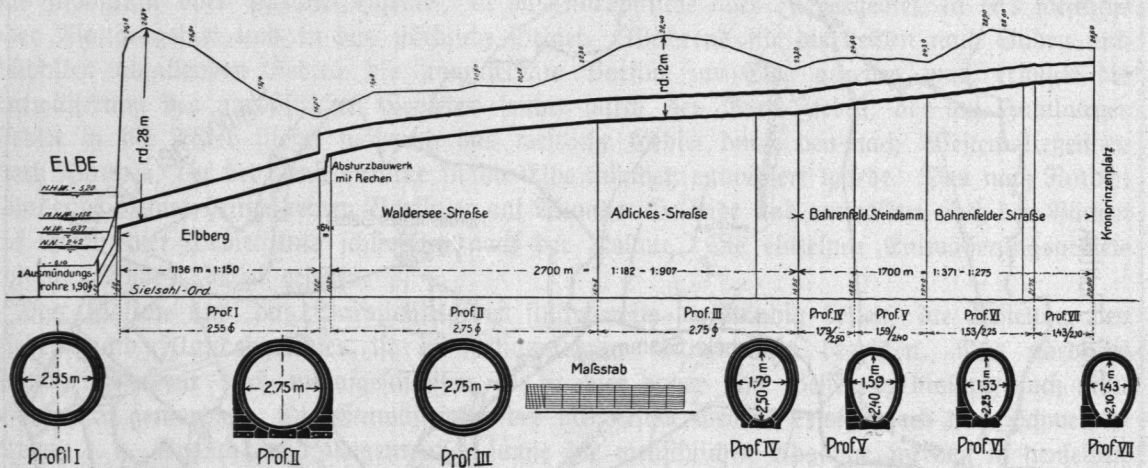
Längenschnitt und Querschnitt des neuen Stammesiefes.
